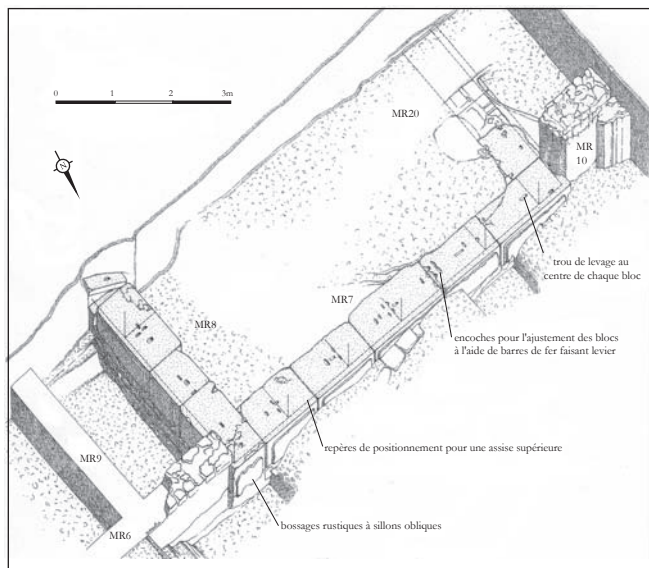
L'île Saint-Martin à Gruissan : plan du bâtiment en grand appareil (d'après Sanchez *et al.* 1999).
